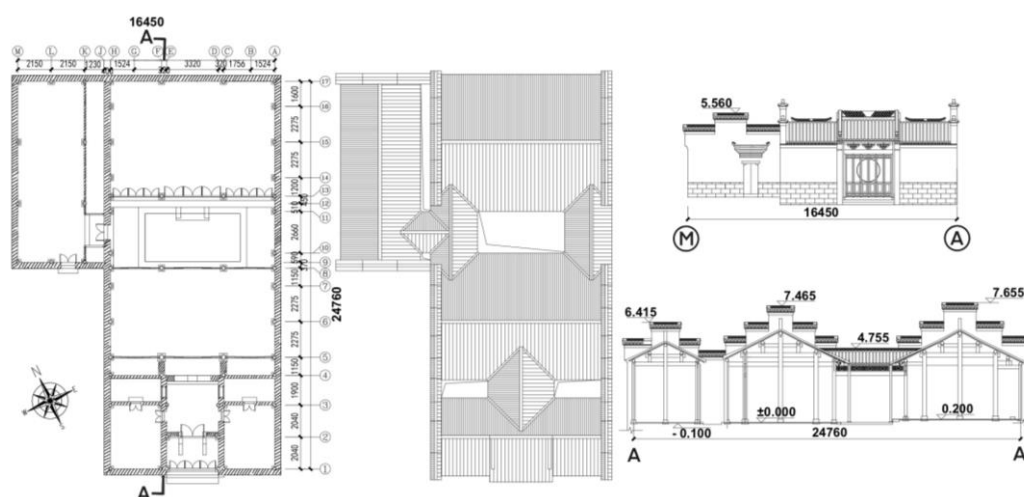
再現した潘氏祠堂の図面(左：平面図 中：上面図 右上：正面図 右下：A-A 断面図)
